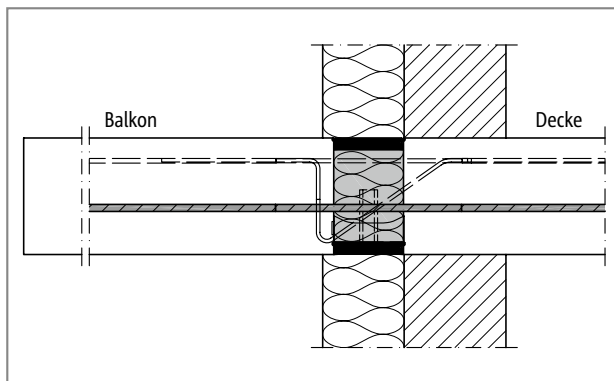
Schöck Isokorb® XT Typ KL, HP-NN: Mauerwerk mit Aussendämmung
